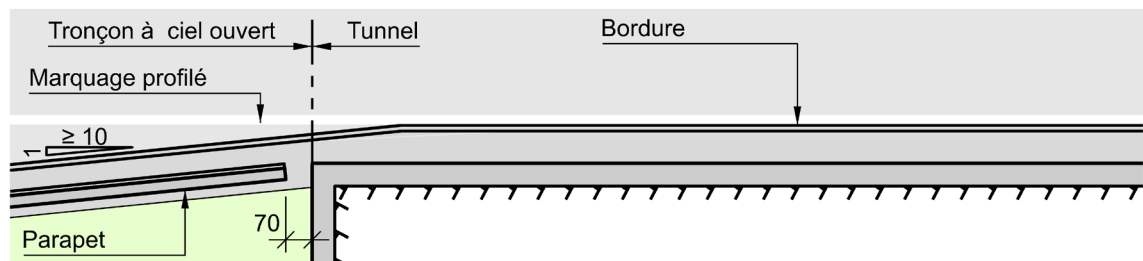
Variante 3a – Le parapet se termine avant l'entrée du tunnel
